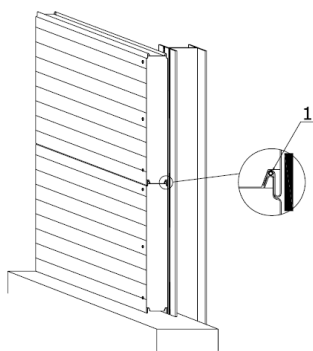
Установка уплотнителя. 1 – трубчатый уплотнитель (герметик)
